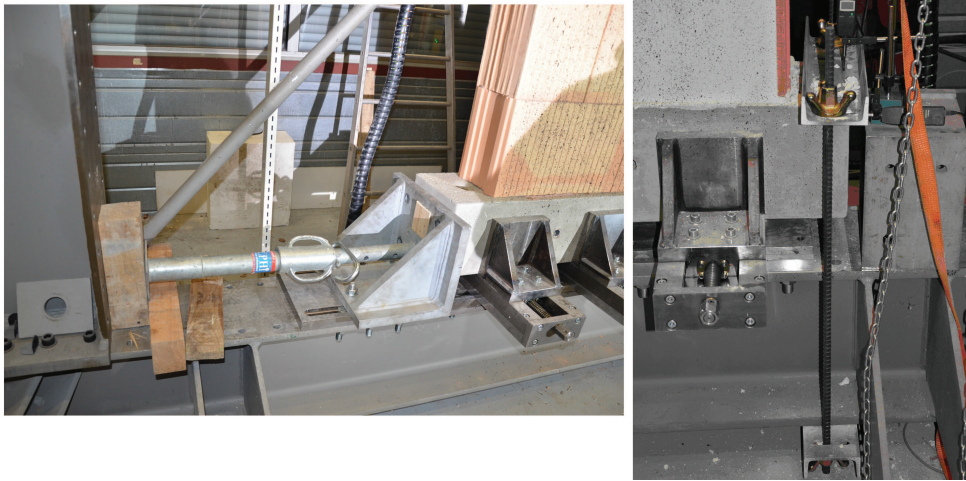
Blocages de la poutre inférieure par rapport au glissement (gauche) et au soulèvement (à droite).
